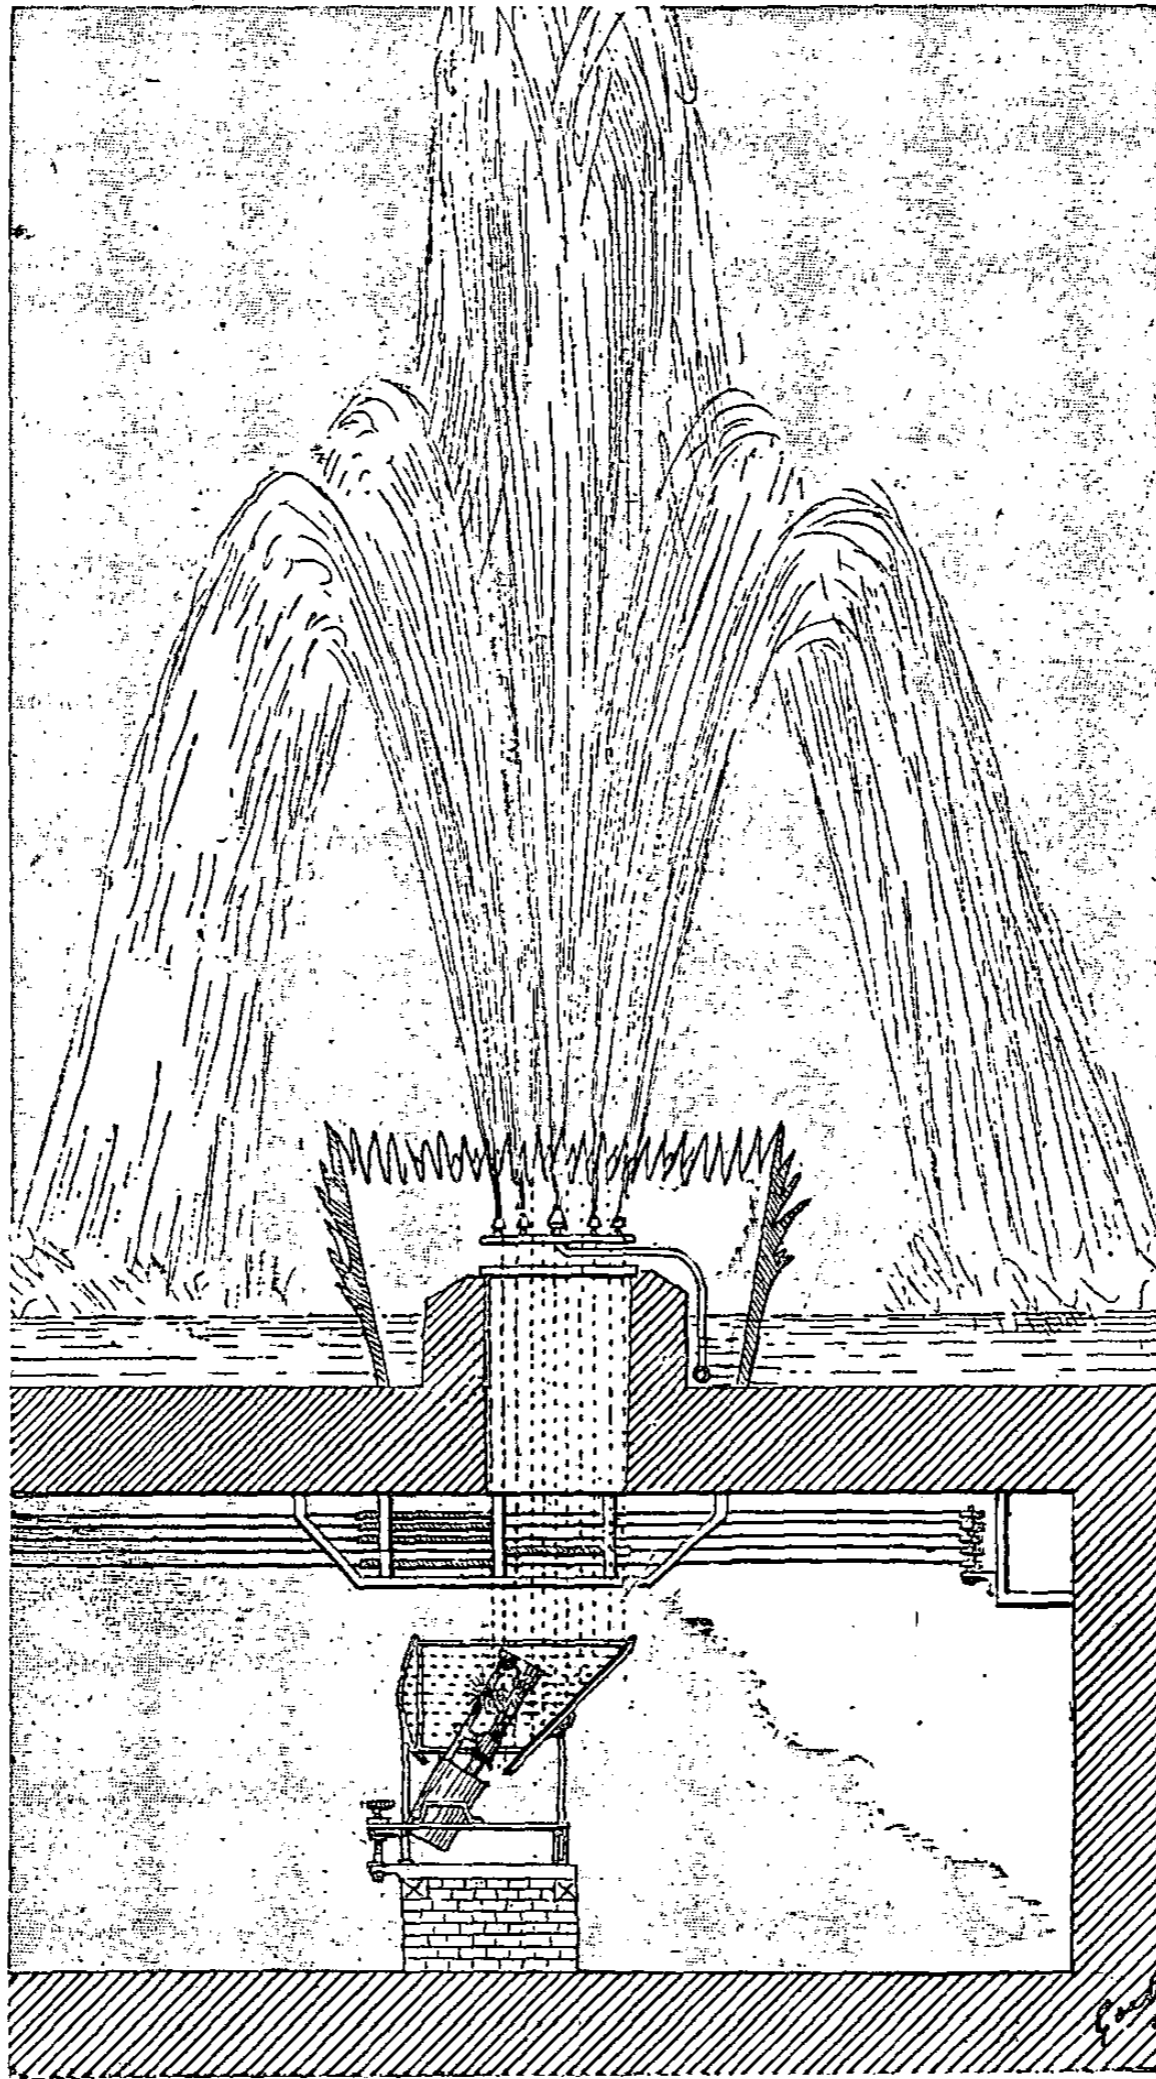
Coupe de l'installation d'une lampe Sautter-Lemonnier.
